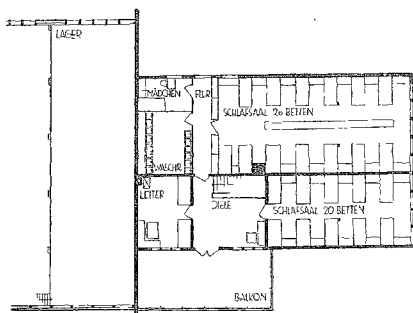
Grundriß vom Obergeschoß des Wohnhauses
